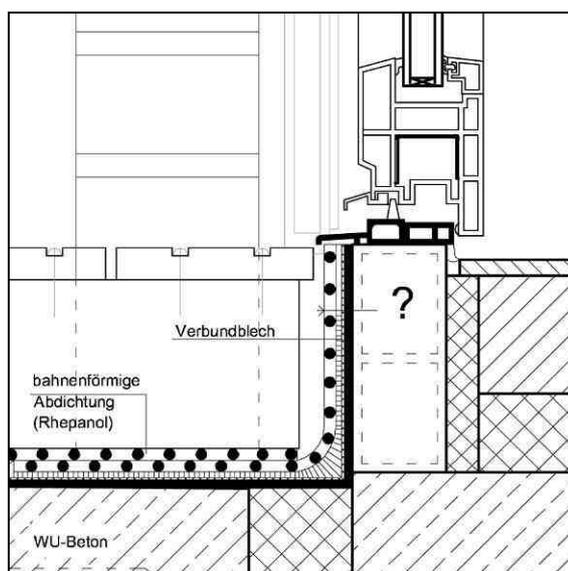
Detailschnitt Balkonschwelle
